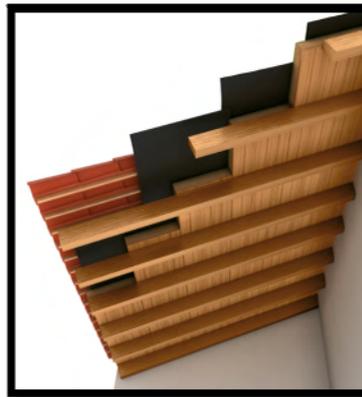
Detalle del aislamiento de la cubierta (www.rockwool.es)
